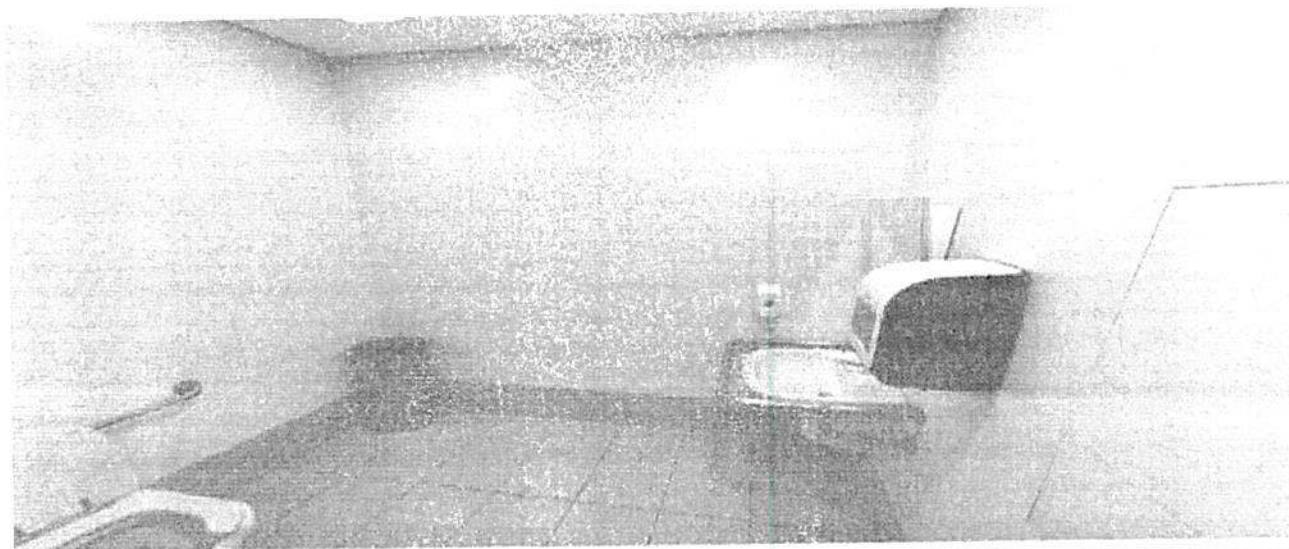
Imagem do banheiro acessível do 8º pavimento
